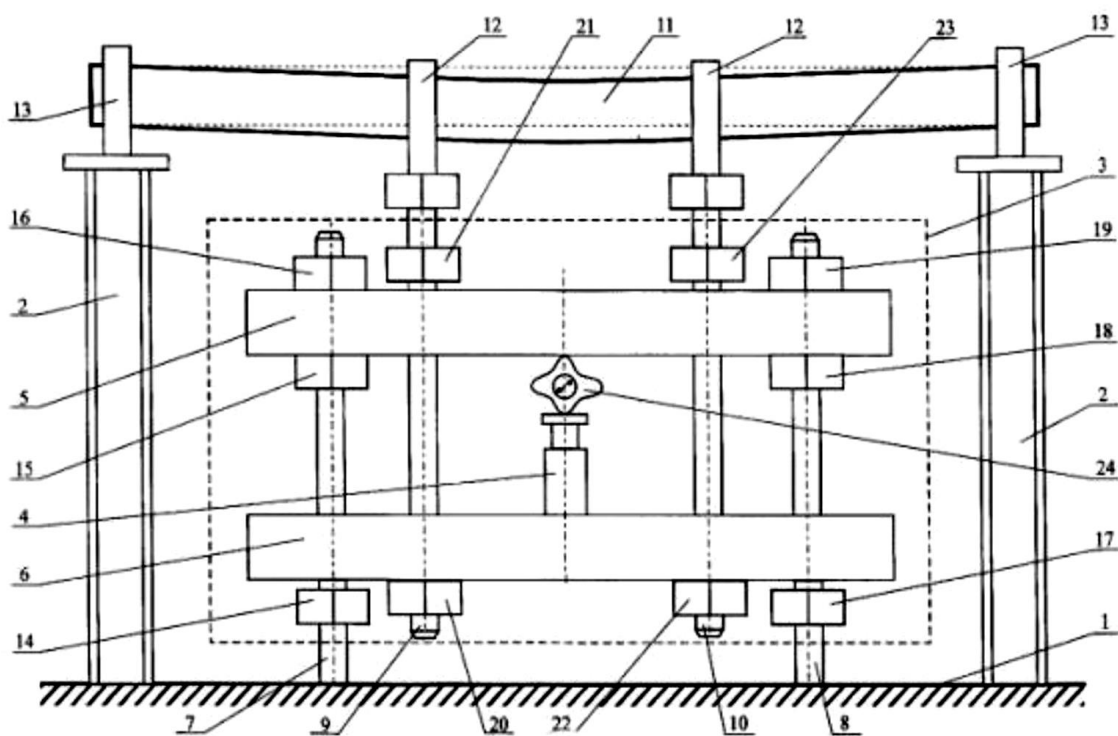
Вид испытательной установки для железобетонных балок [39]
